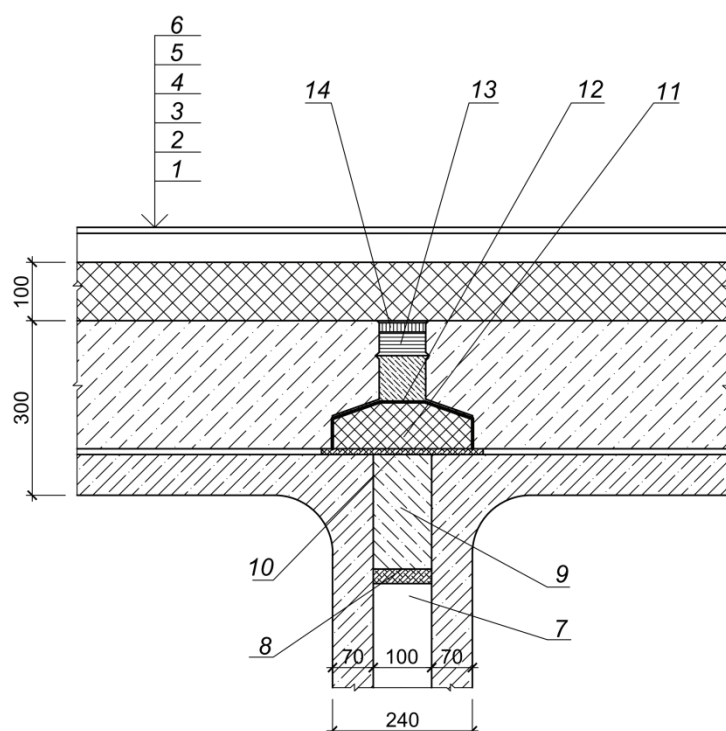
Схема проектного решения узла сопряжения наружной стены с внутренней (крепление облицовки фасада условно не показано):
